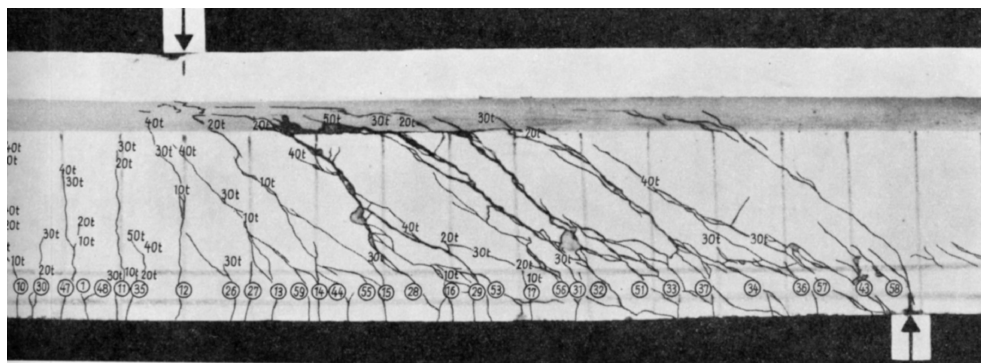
Rissbild und Stegdruckbruch für den Balken TA15 nach Leonhardt und Walther [96]
